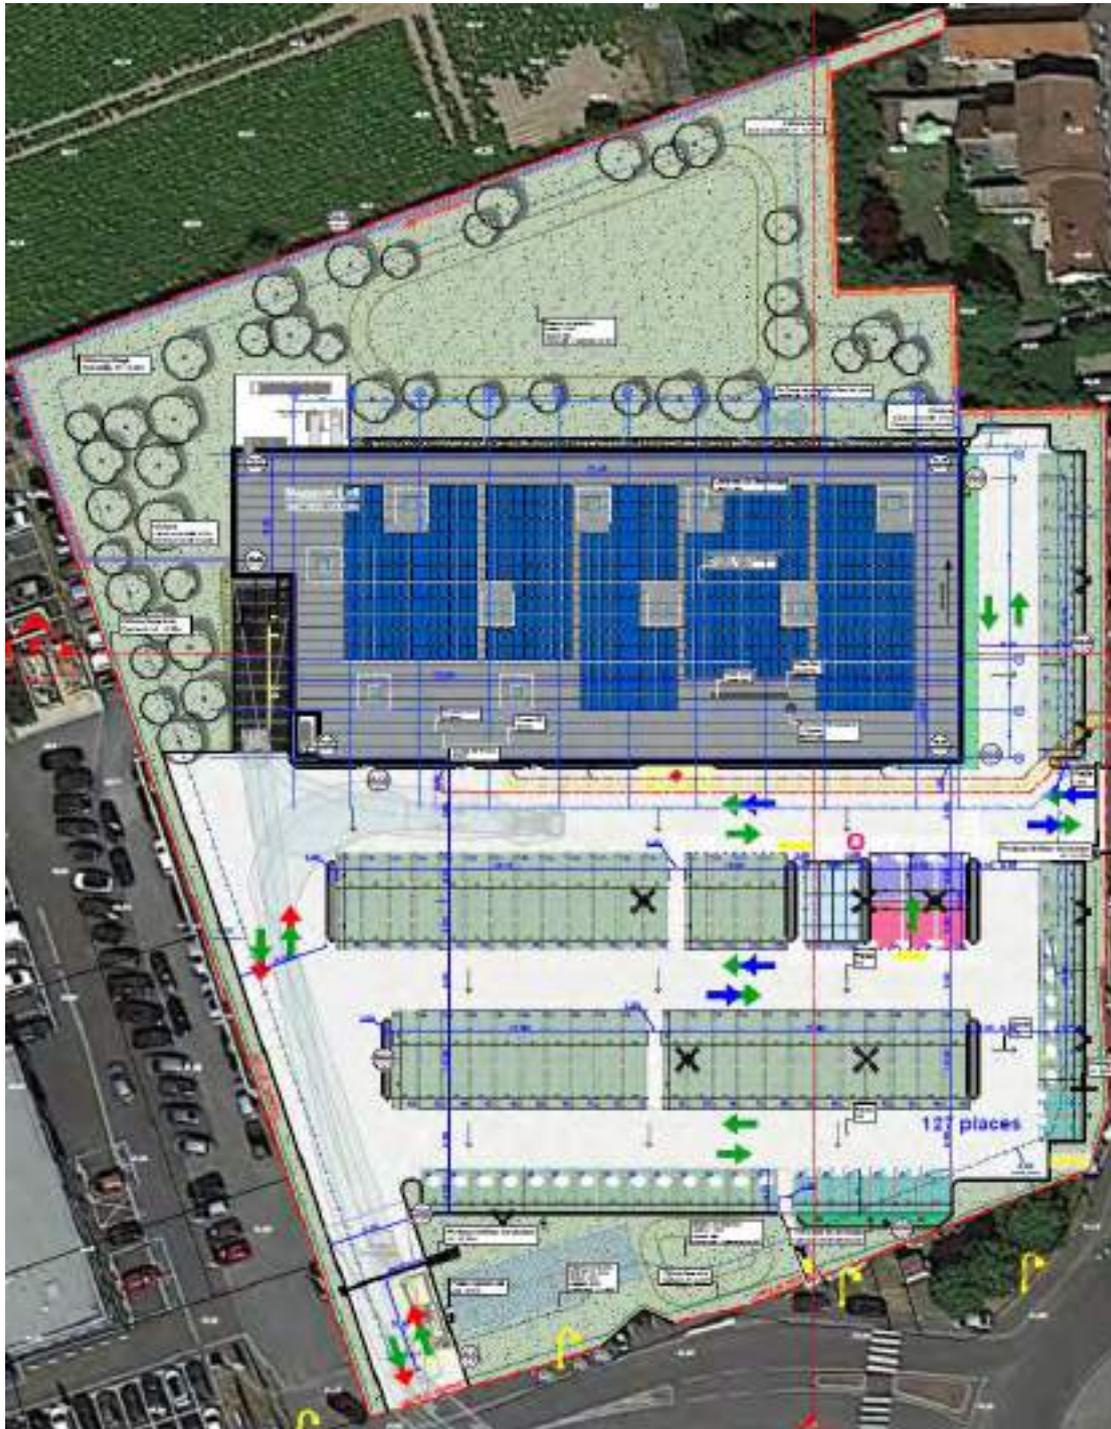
Extrait du plan de masse du niveau RDC daté du 15/09/2021
